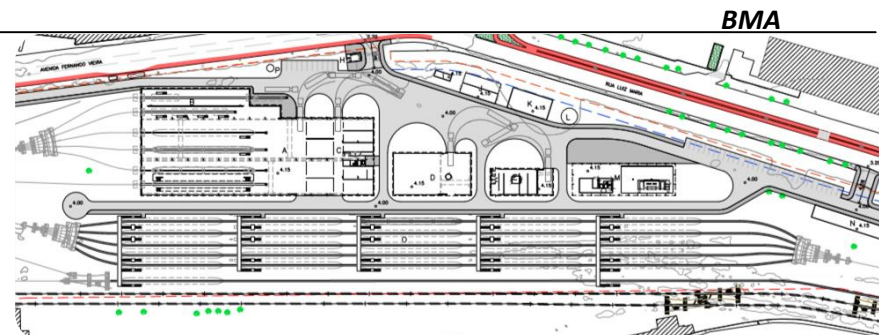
Planta Baixa do Pátio de Manutenção.
